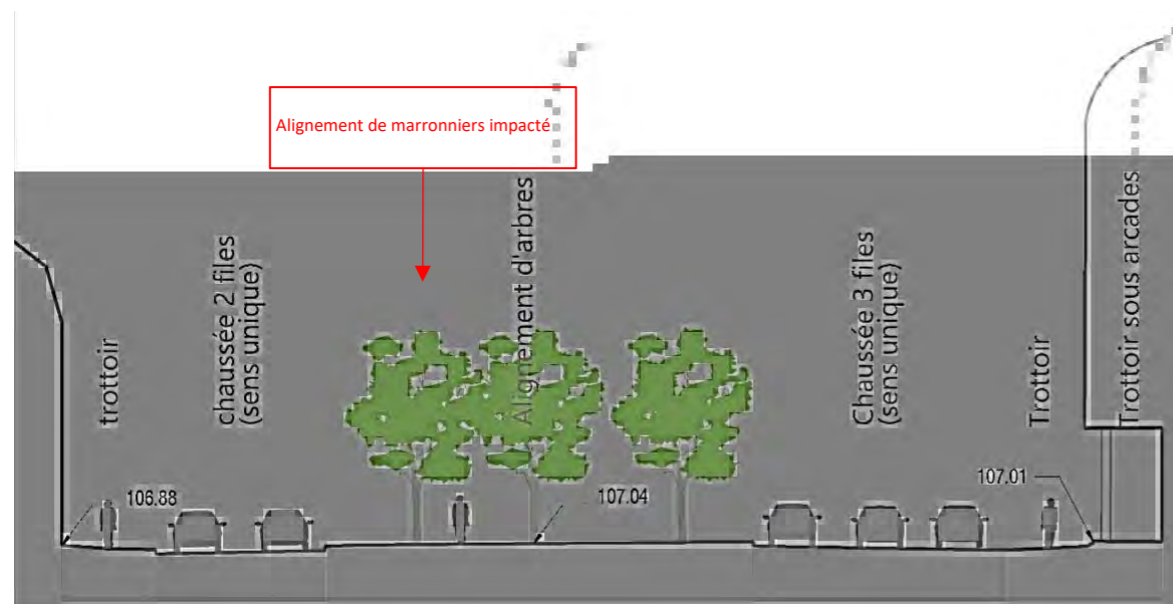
Profil existant du boulevard Jean Zay (Source : groupement AMO – étude Plan Guide 2023)
